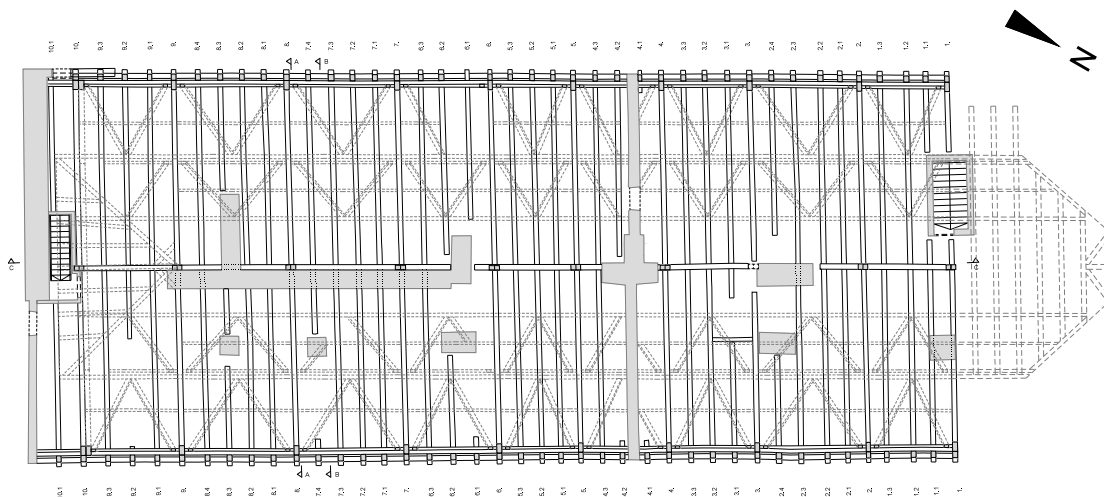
Grundriss Dachwerk Nordosttrakt
